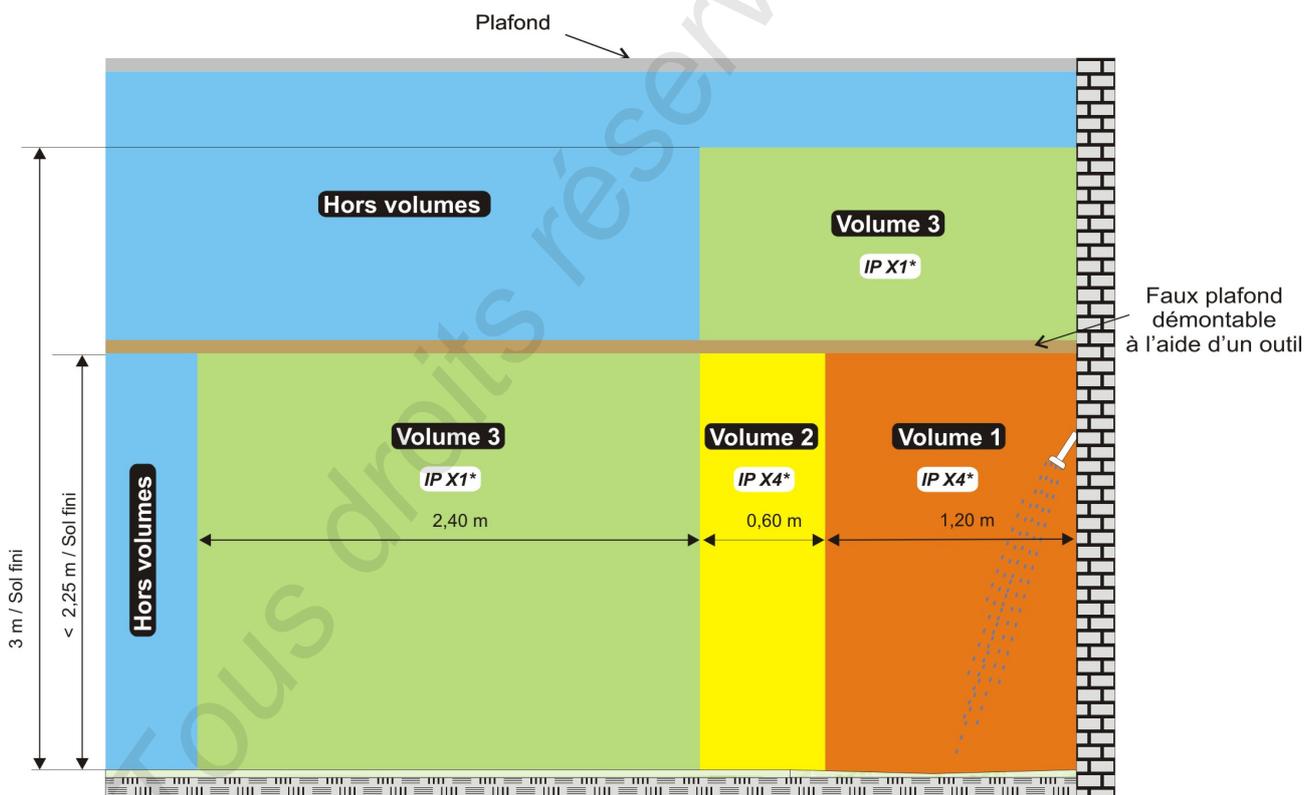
S – Faux plafond démontable à l'aide d'un outil situé à moins de 2,25 m du fond du receveur ou de la baignoire
